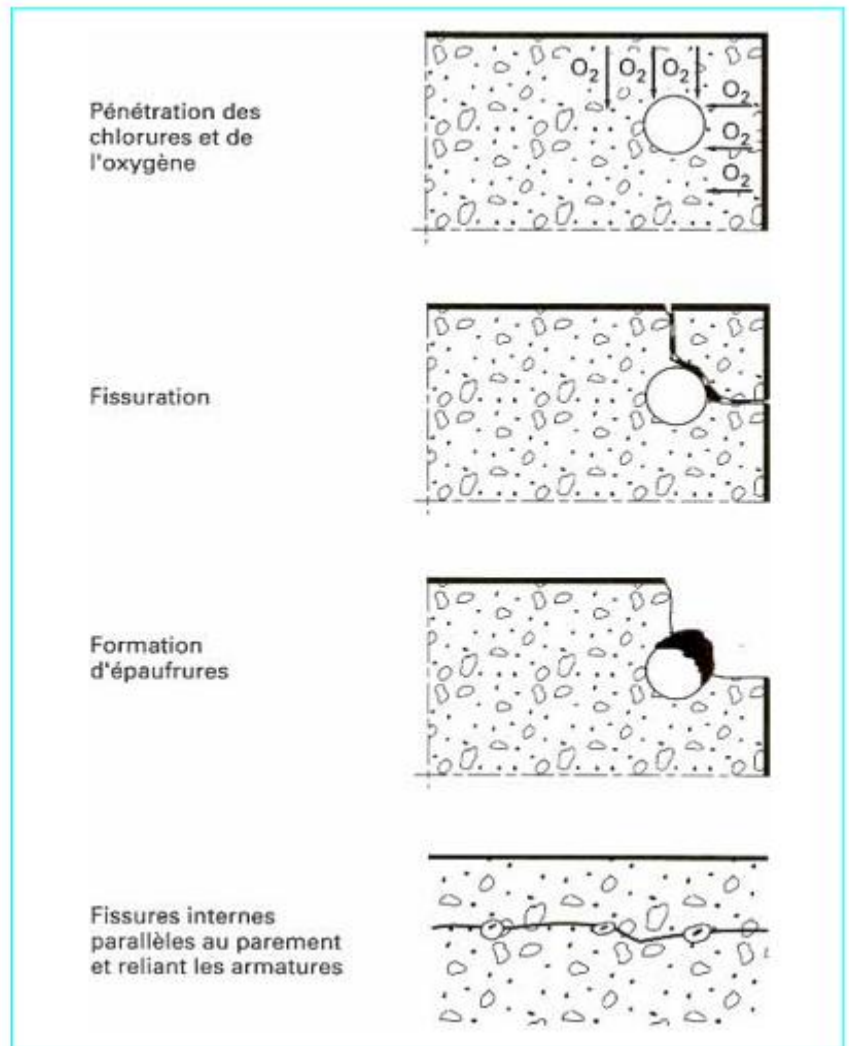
Processus de déroulement de fissuration due à la corrosion
